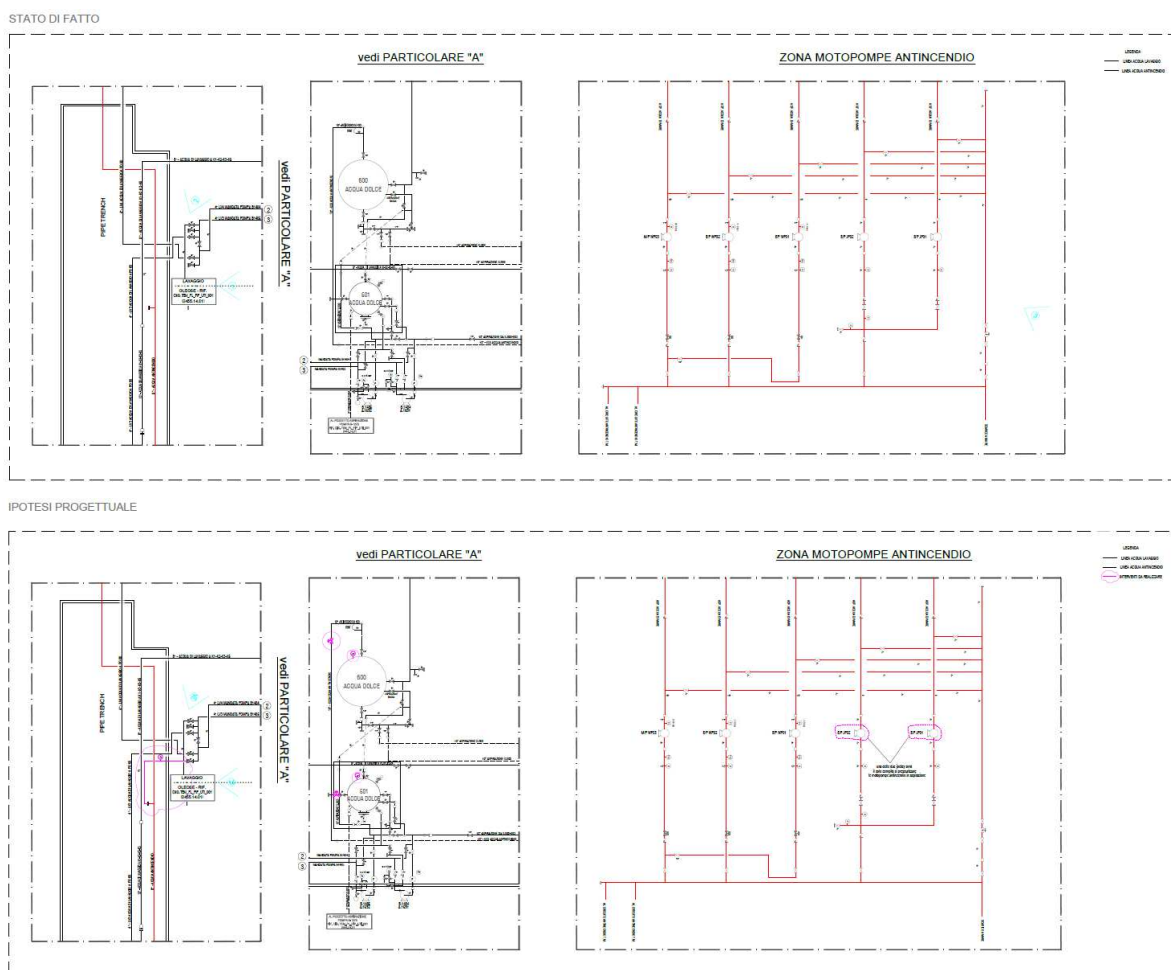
Stralcio planimetrico stato di fatto e di progetto sistema di pressurizzazione impianto antincendio
